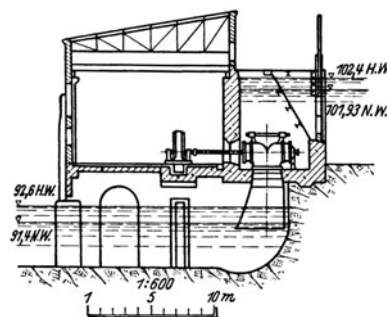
Häfreström. Lageplan und Krafthausschnitt. (Tekn. Tidskr.)
